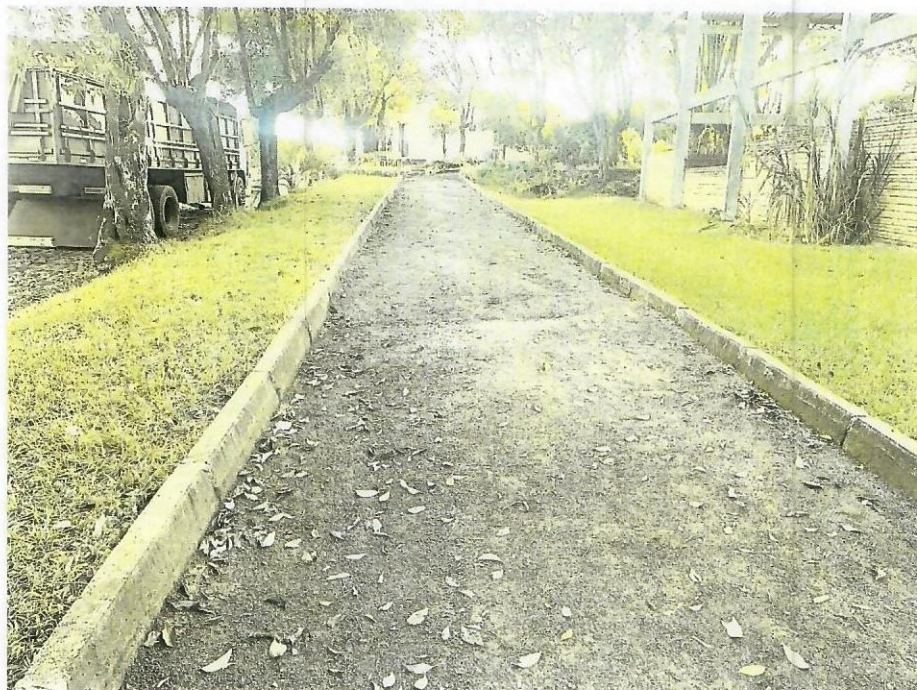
Pista de caminhada existente, será realizado nivelamento e colocação de uma nova cama de pó de pedra
